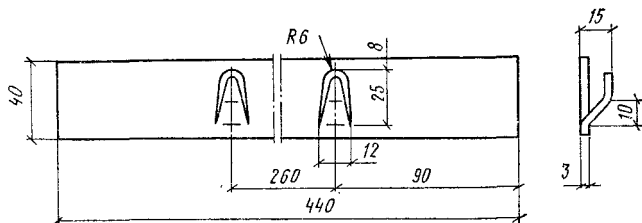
Кронштейн типа 22кс (масса 0,414 кг) для крепления высоко располагаемых смывных бачков на кирпичных или бетонных стенах дюбель-гвоздями
